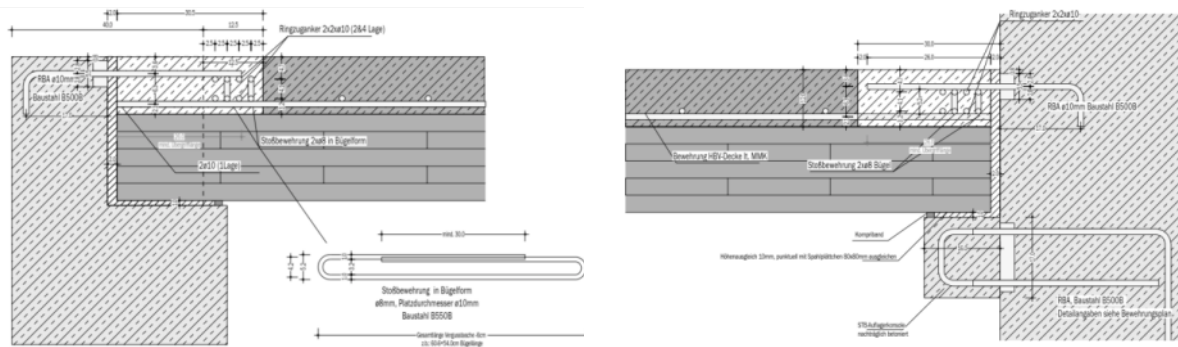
Deckenauflegerdetails mit Bewehrungsanschlüssen
